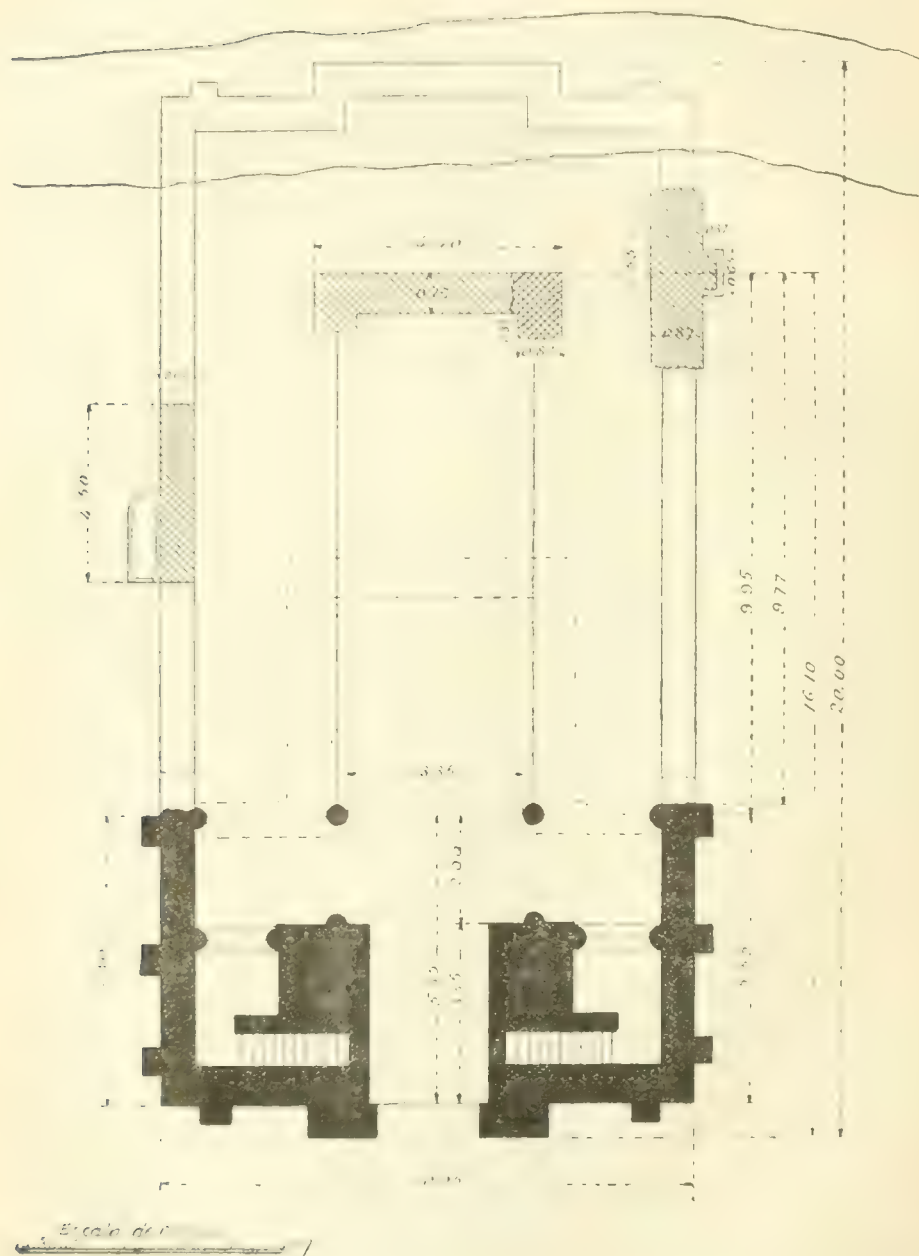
Plan de las excavaciones practicadas por el Sr. Llano Roza.
